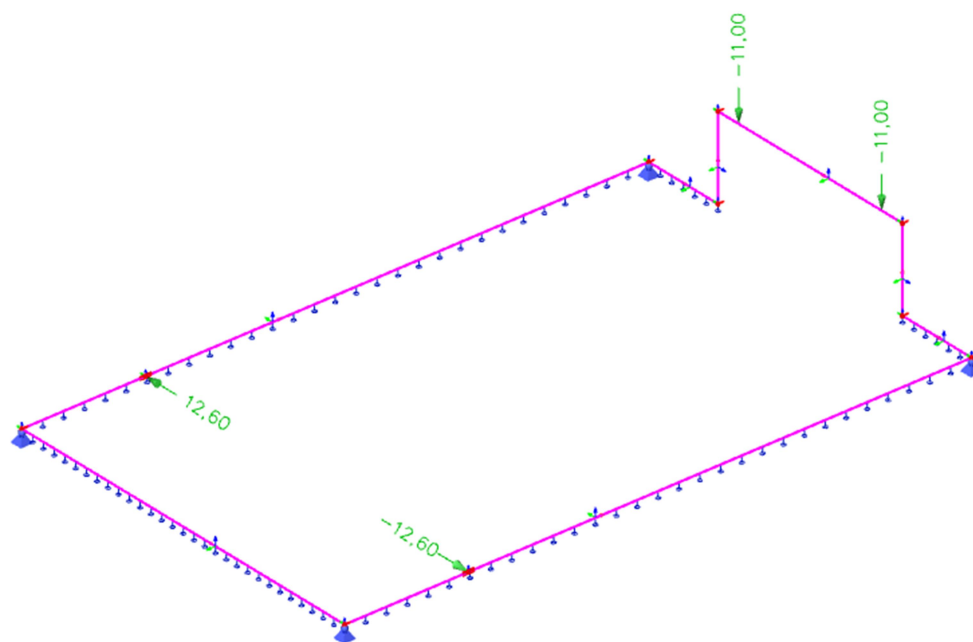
Konstrukce 2, Zatěžovací stav ZS2
